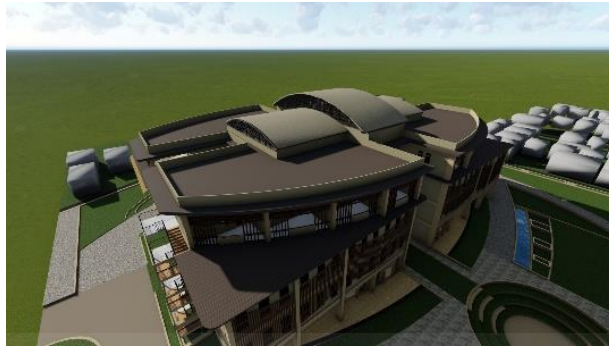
Rancangan Bentuk Bangunan Lantai 3
